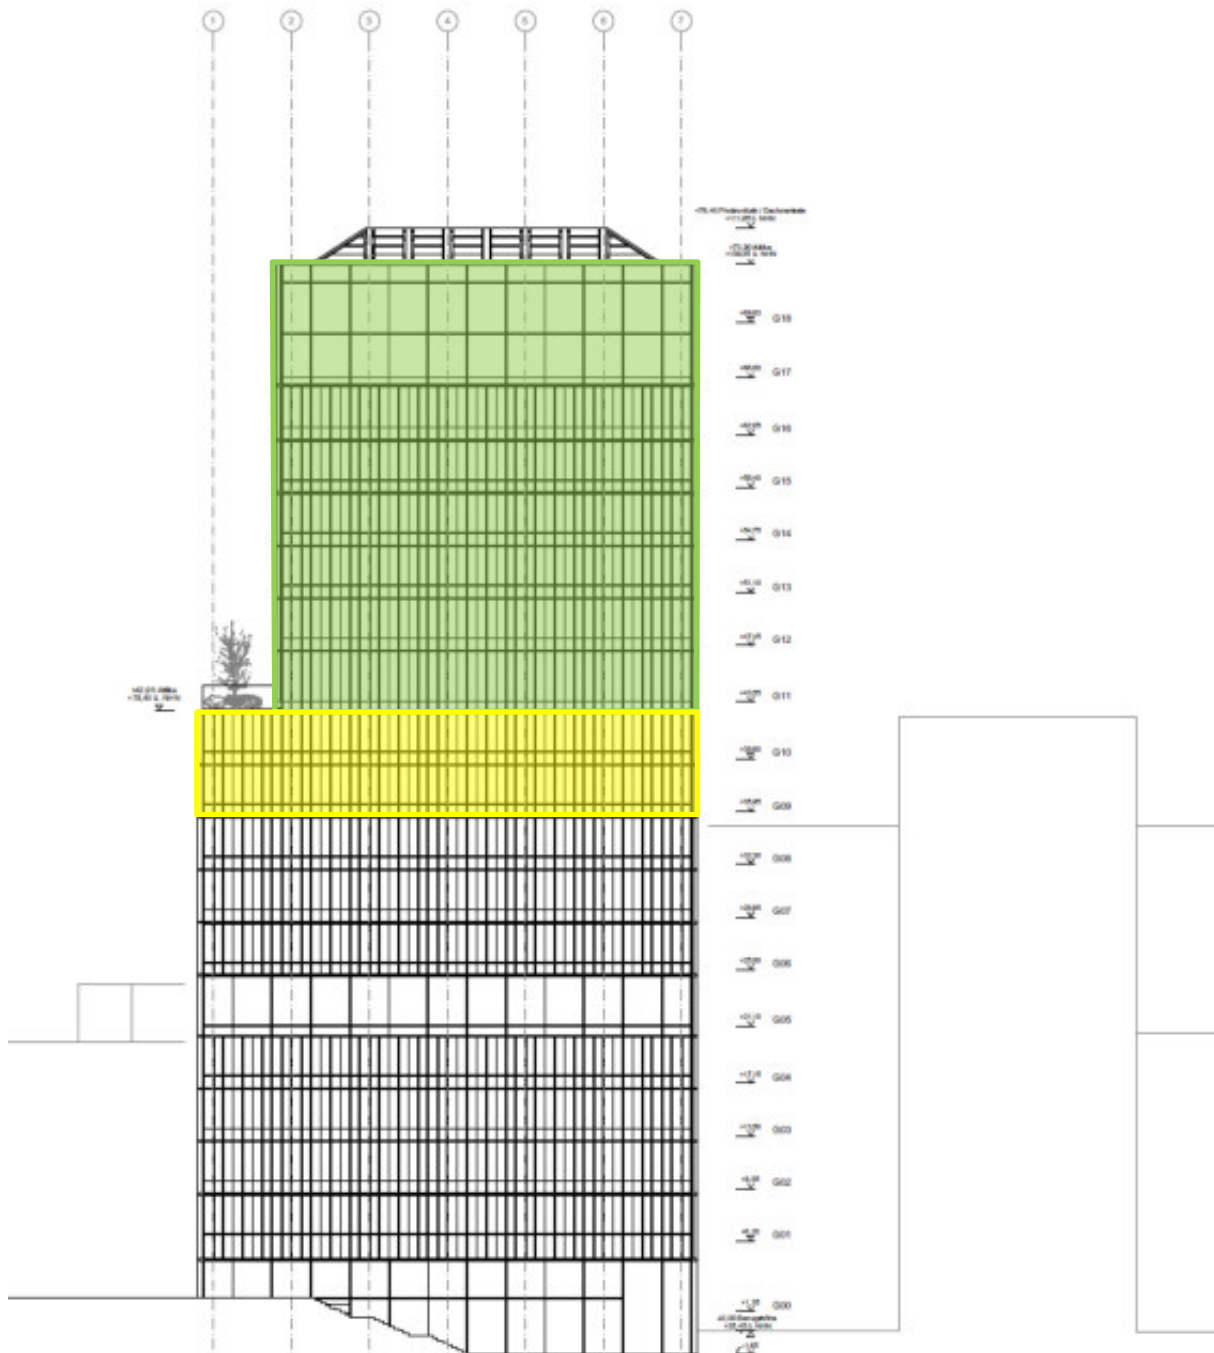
Südwestansicht des geplanten Baukörpers (Quelle: David Chipperfield Architekten)
